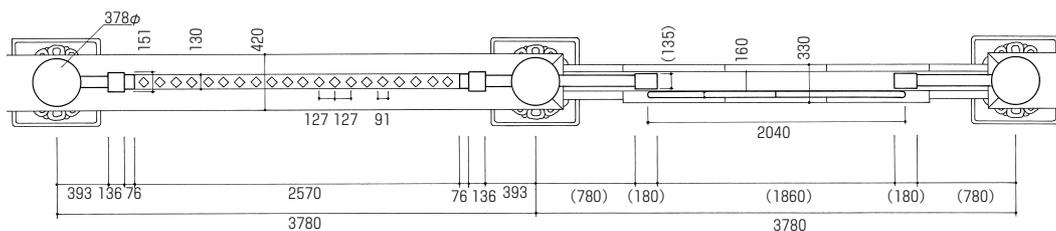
回廊 連子窓・窓扉まわり復元平面図 1:60
